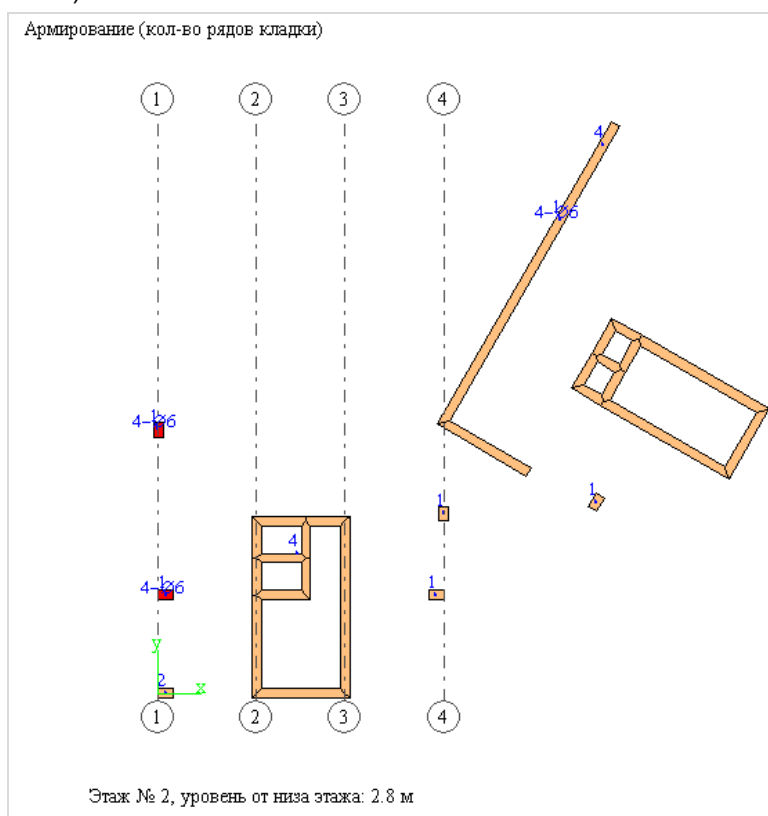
Армирование стен, этаж №2, отметка 2.800
